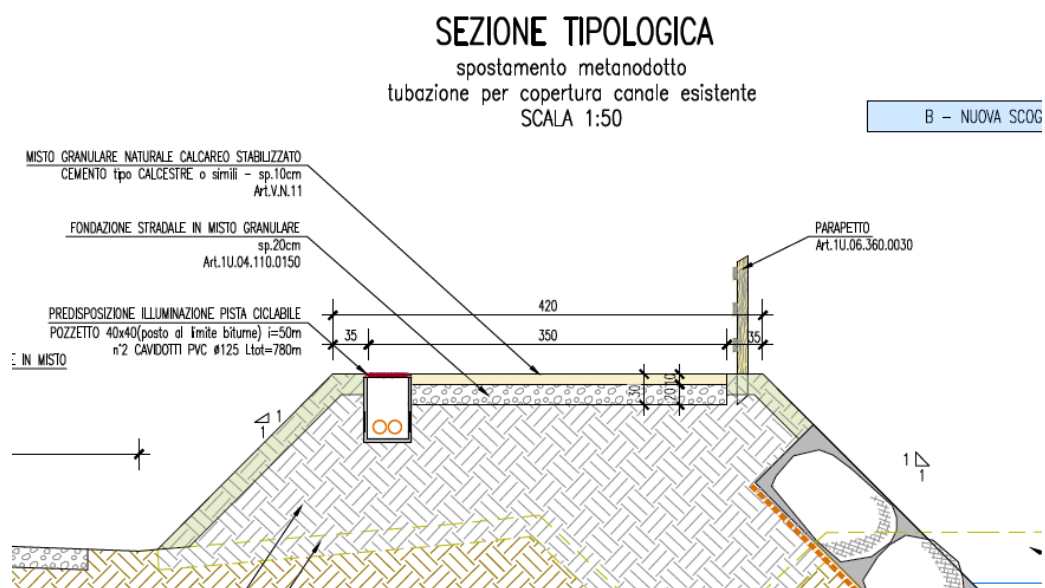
sezione tipo della pista ciclopedonale ricavata sul nuovo argine del Garza.
